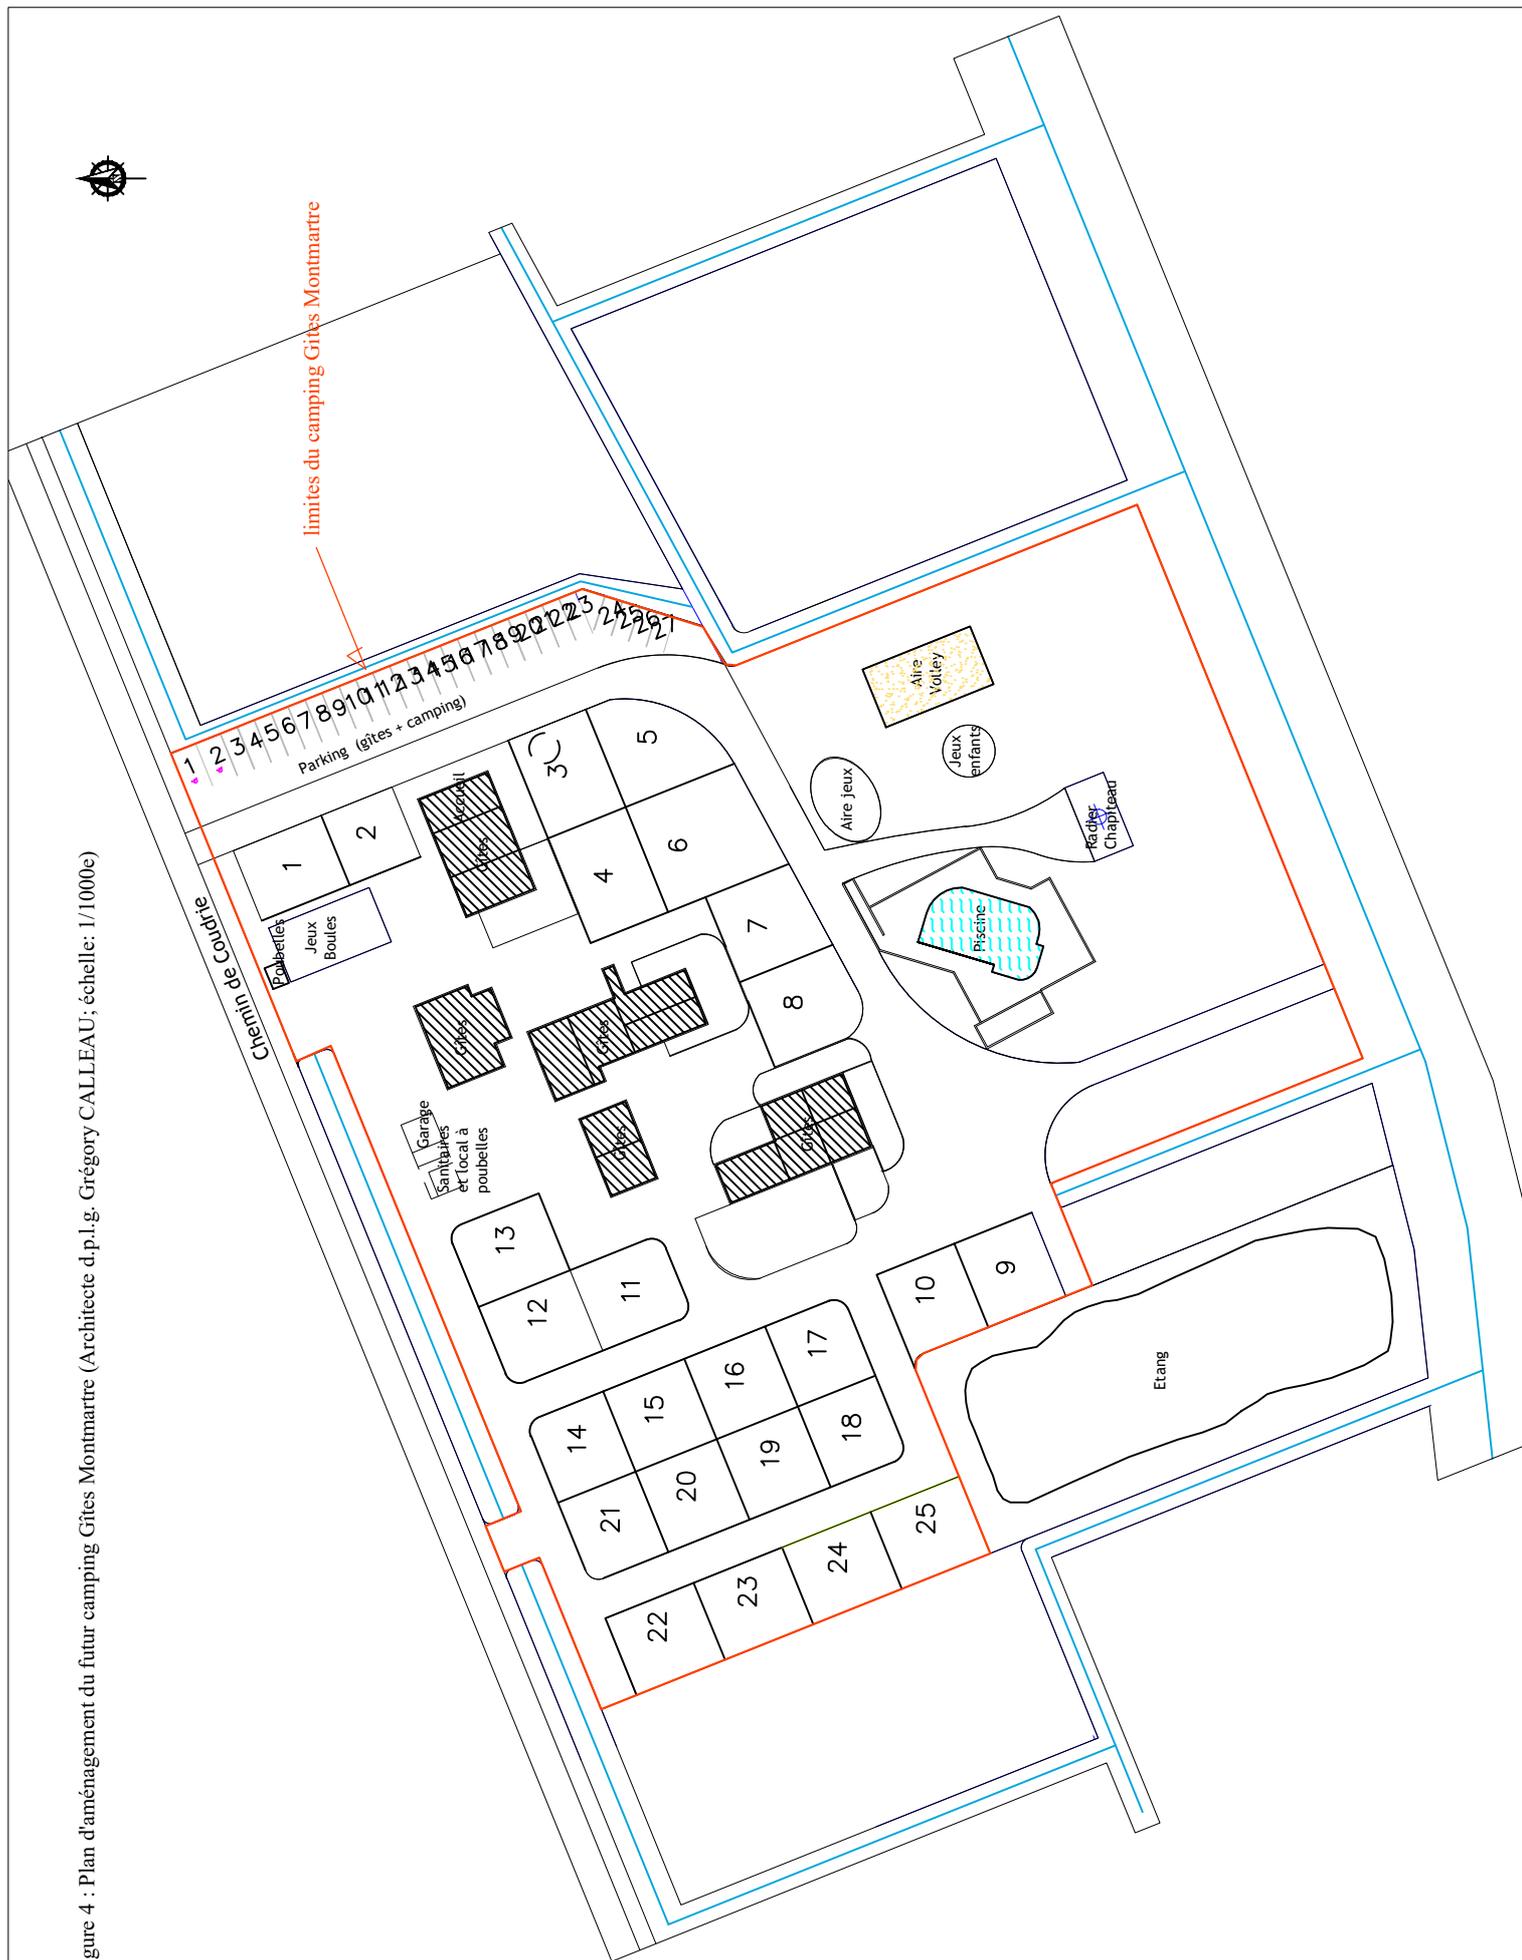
Plan d'aménagement du futur camping Gîtes Montmartre (Architecte d.p.l.g. Grégory CALLEAU; échelle: 1/1000e)
